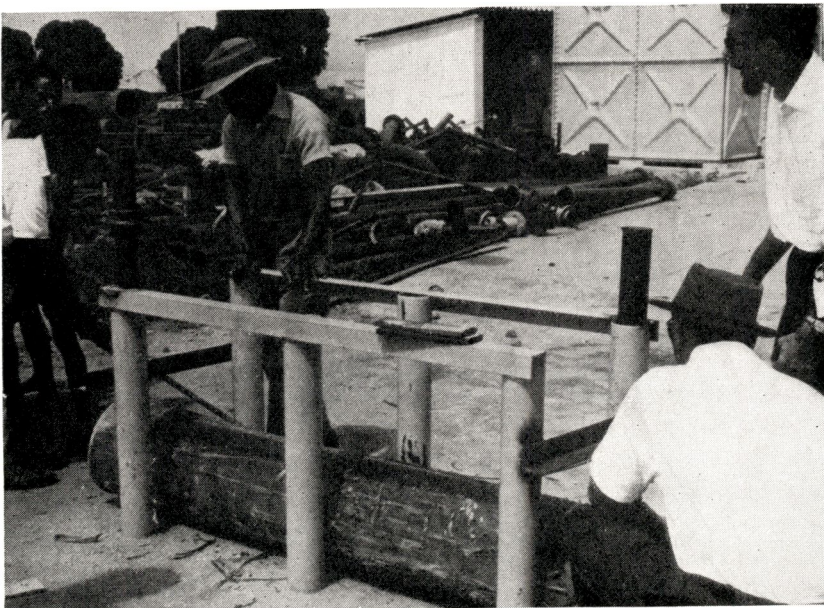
Le poteau étant mis en place, on vérifie la longueur d'encastrement
